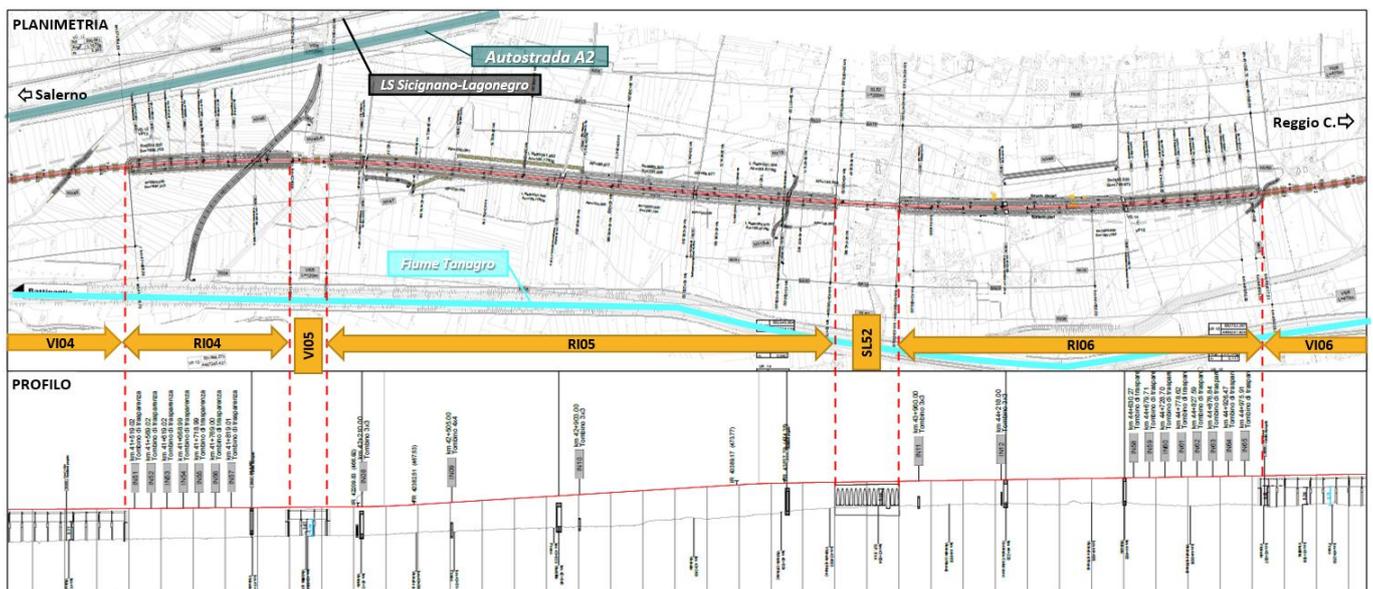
Planoprofilo di progetto da km 41+486 a km 45+026
